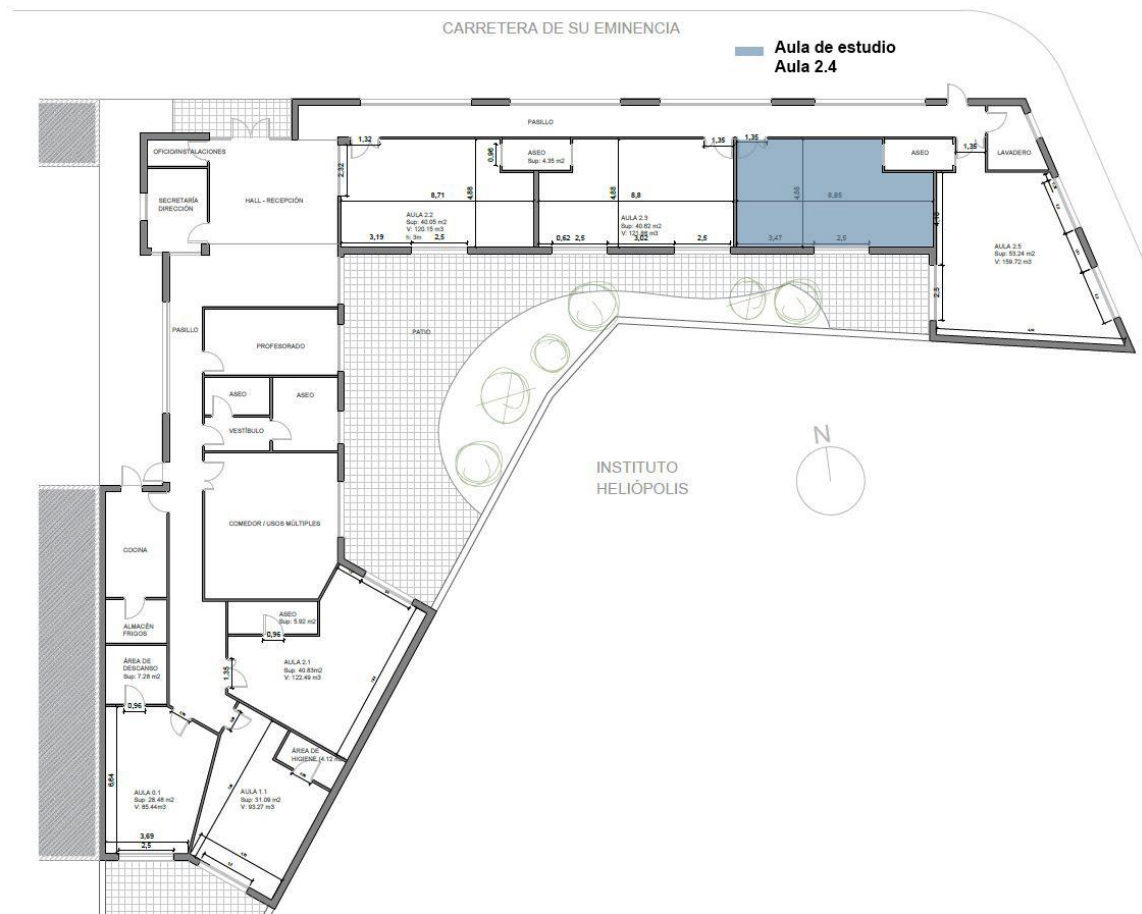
Planta baja del CEI El Nido de la Palmera y aula de estudio. Planos aportados por el Centro.
